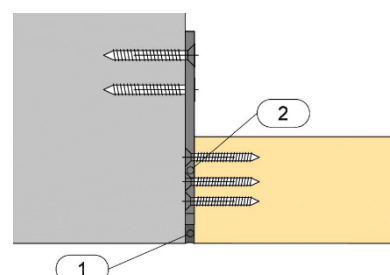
mit Stahl U – Profil 30 x 14 / 3
